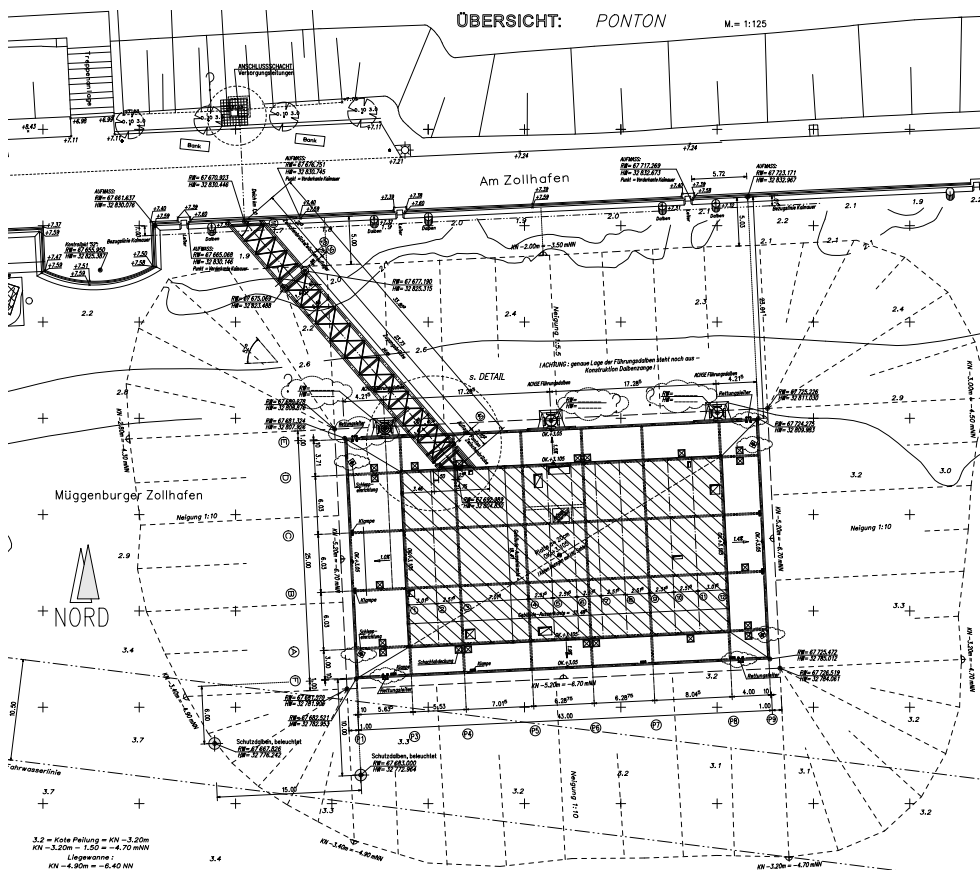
Lageplan mit Pontongrundriss und Zugangsbrücke, 2009 (genordet)
